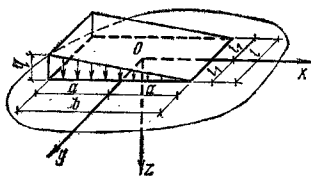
Треугольная нагрузка по площади прямоугольника
